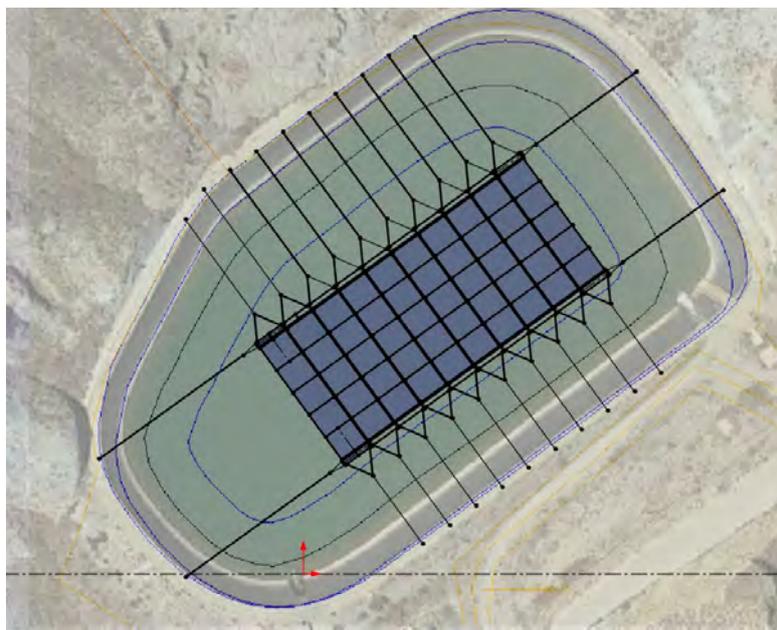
Vista en planta de la instalación fotovoltaica sobre la Balsa Abellán
